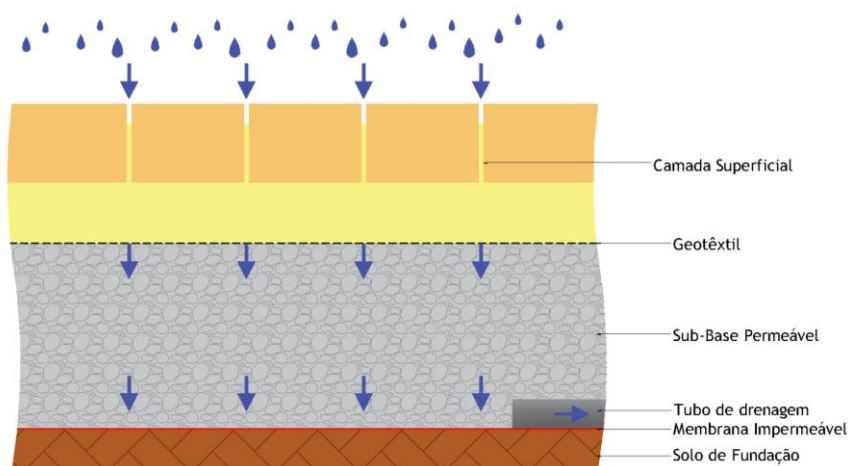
Sistema sem infiltração (Adaptado de Tenreiro, 2016)
